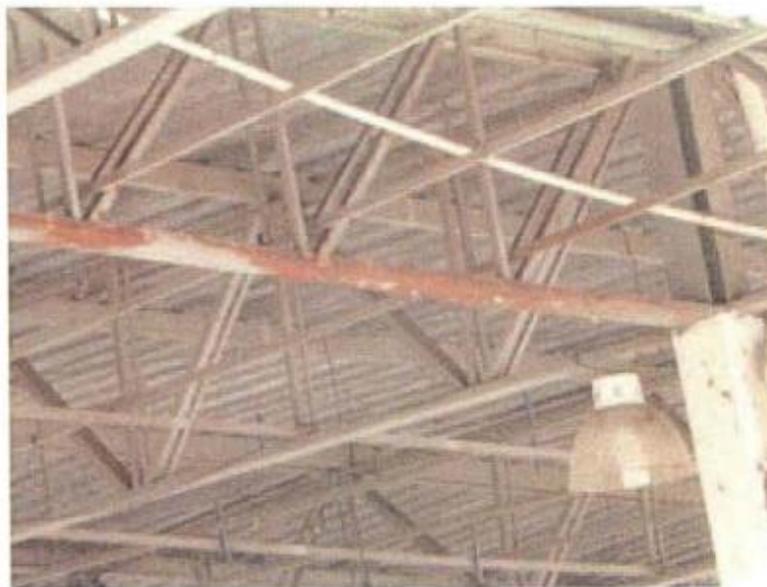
km 816 - Praça de Pedágio – Estrutura do telhado com corrosão e sujeira acumulada
